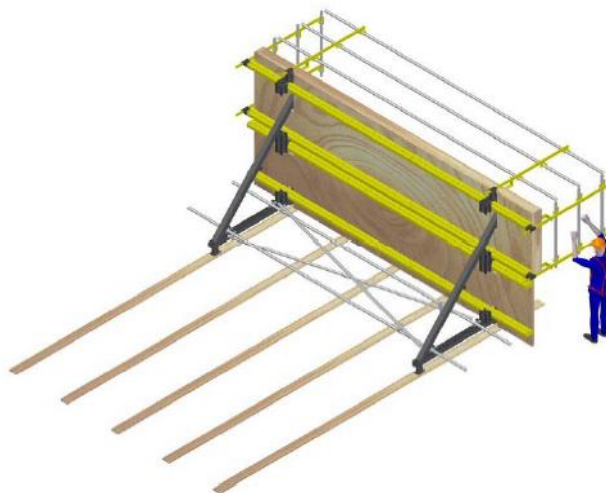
m. Armado de la plataforma principal conforme al punto 22 anterior. Recuperado de: Ulma Construction, *Instrucción técnica de montaje*.
